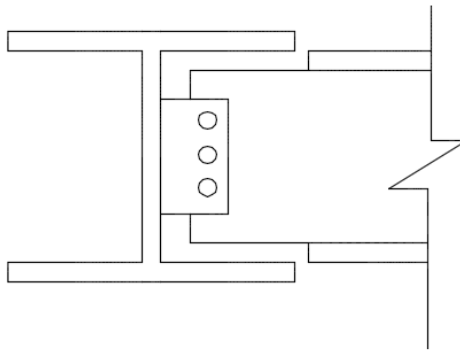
Conexión de cortante tipo Placa Paralela de viga a viga.
